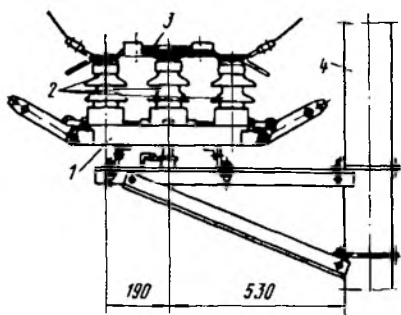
Схема разъединителя наружной установки РЛНТ-10:
